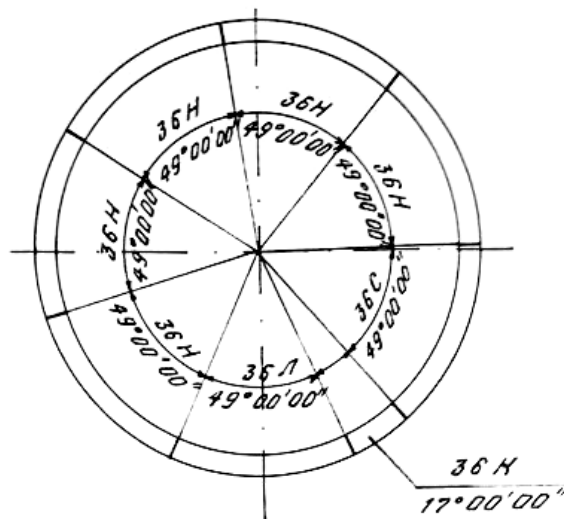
Обделка из обжатых в породе железобетонных элементов до фактически разработанного контура грунта
